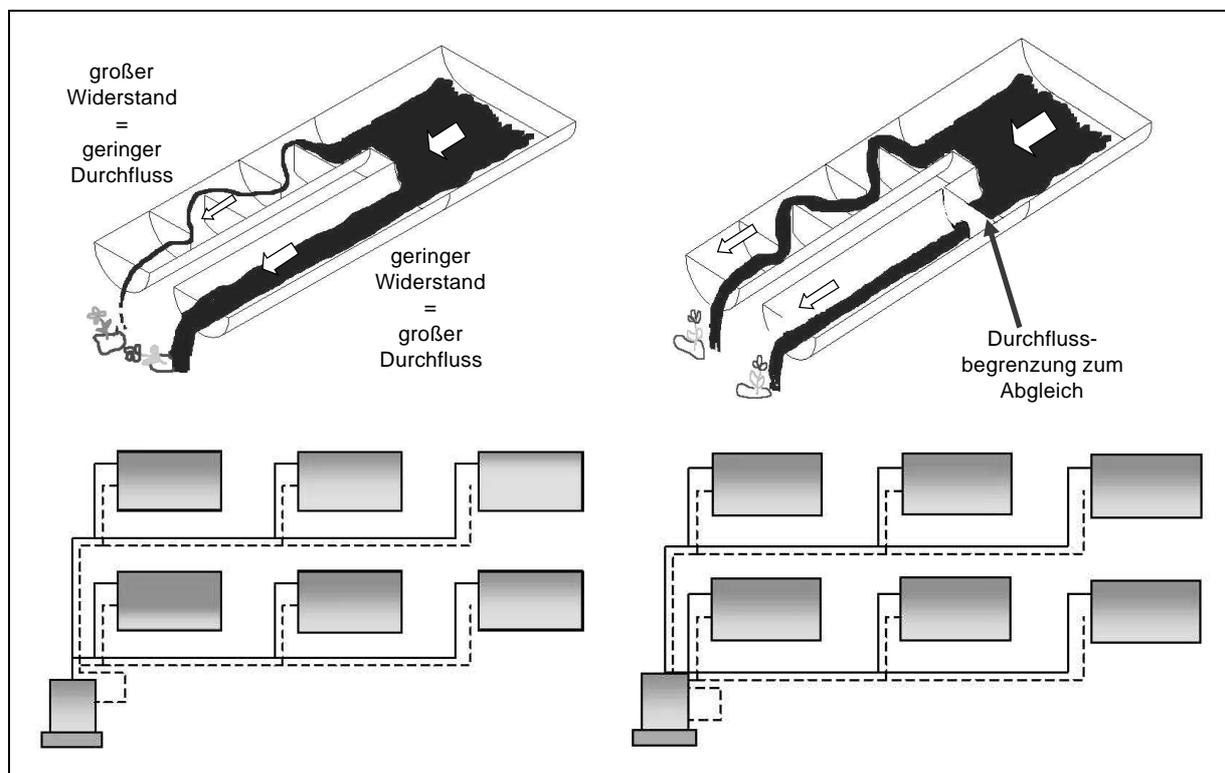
Hydraulischer Abgleich (links: nicht vorhanden, rechts: vorhanden)
